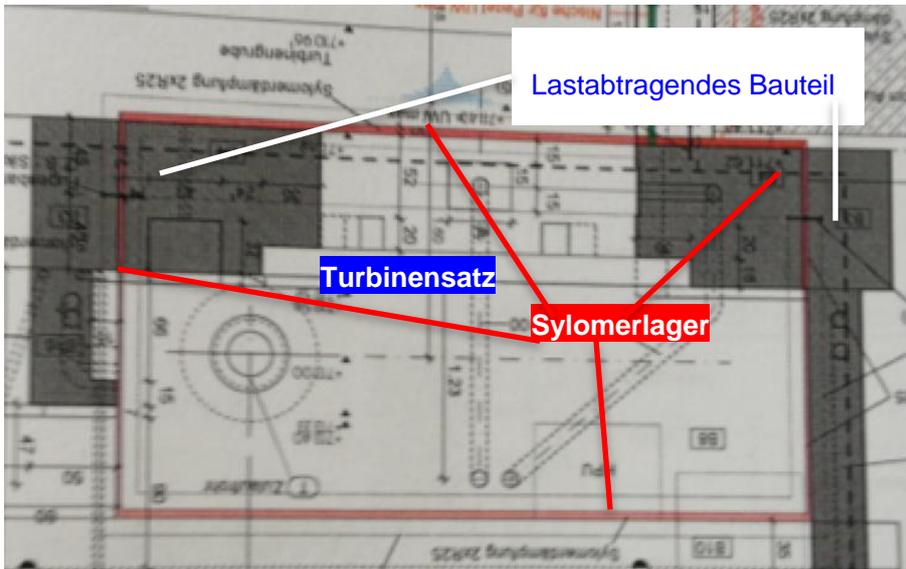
Detail – Körperschall - Sylomerlager⁵⁸⁵
